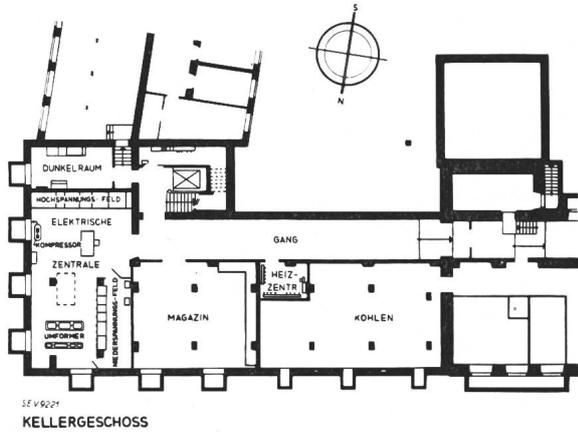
Grundrisse der einzelnen Stockwerke.
